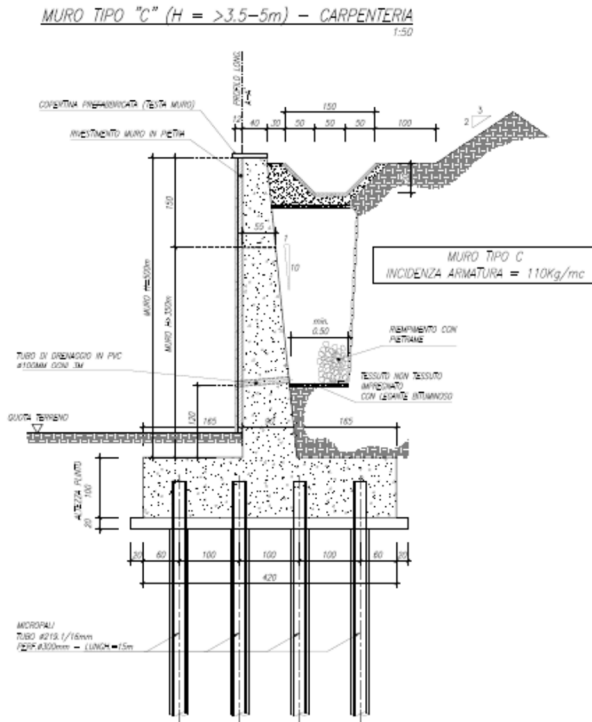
Muri Asse 3 e Asse 5: muro tipo C.
